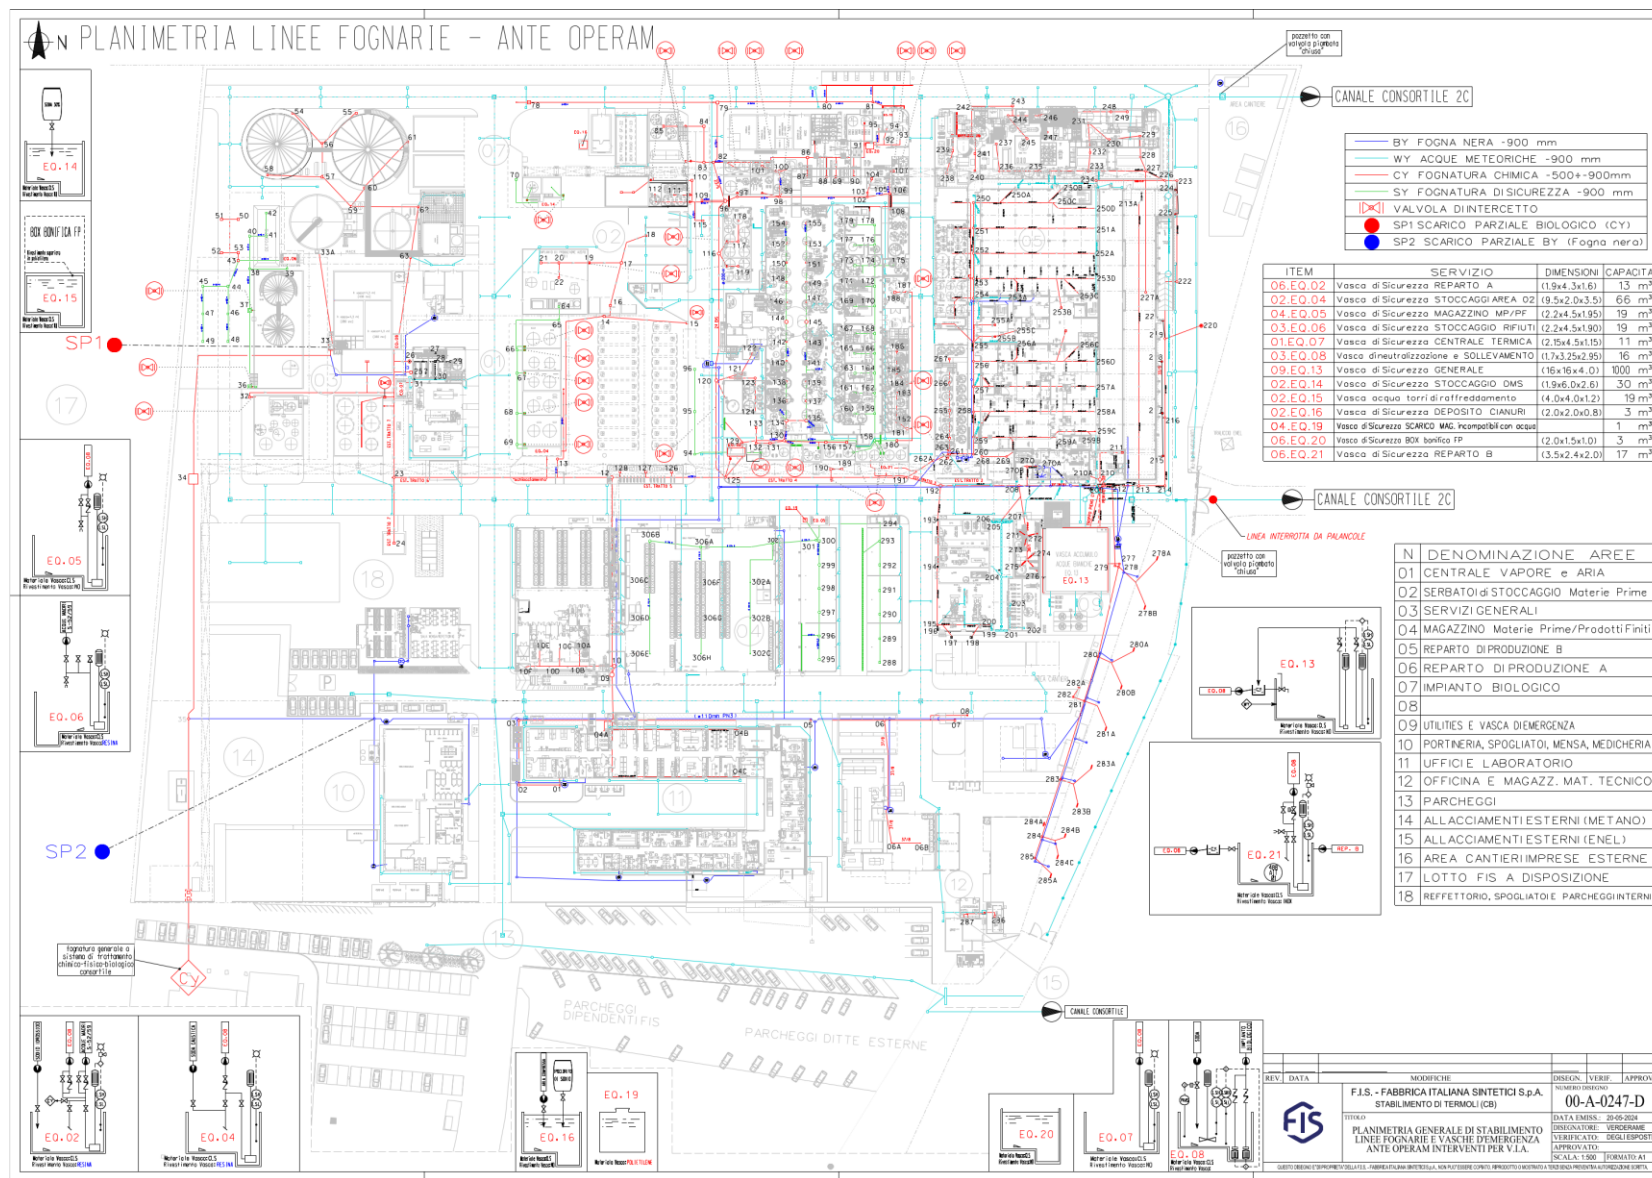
planimetria generale di stabilimento con indicazione delle linee fognarie: assetto "ante operam"
